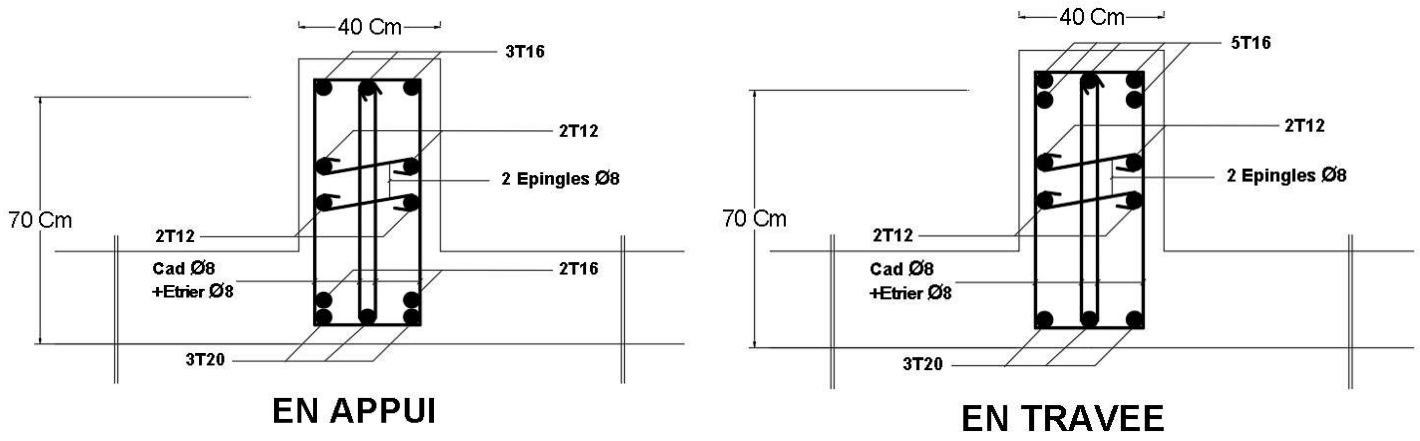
Ferrailage des poutres en travée et en appui.
